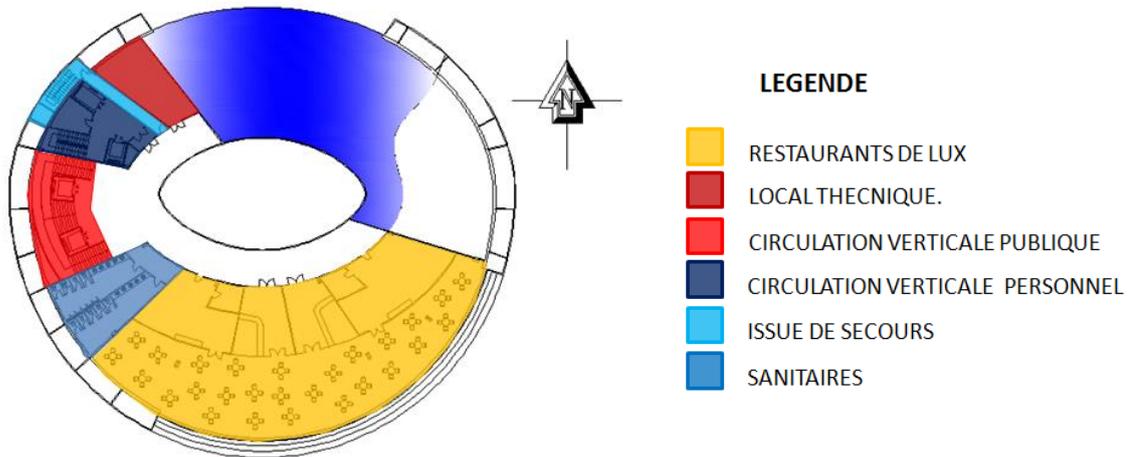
Plan traité du 7ème étage au niveau +30.60.
